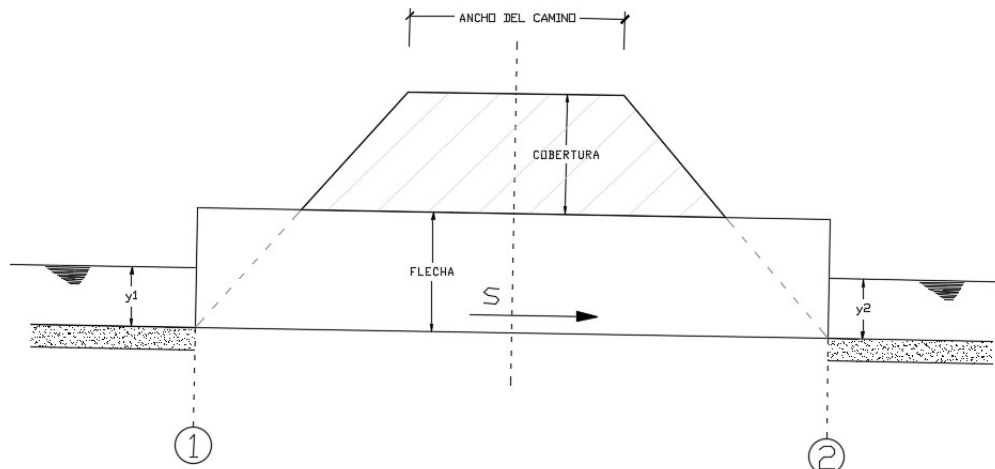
Elementos de perfil de una alcantarilla. Fuente: Elaboración propia adaptado de (Villón, Diseño de estructuras hidráulicas, 2005)
